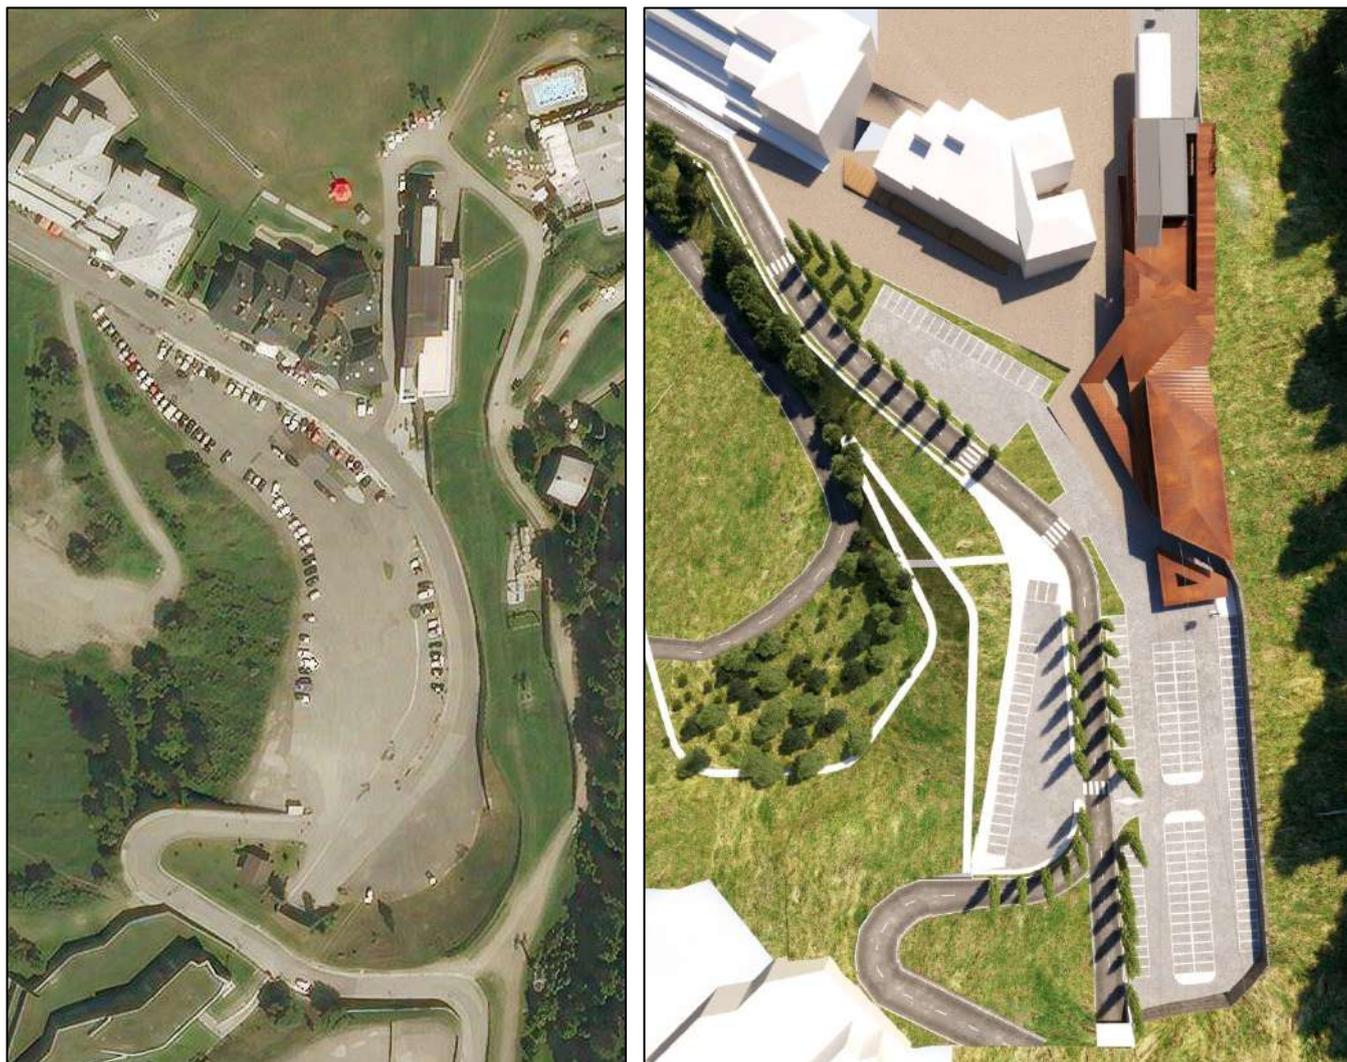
ASSETTO URBANISTICO E VIABILITÀ – STATO ATTUALE E RENDERE DI PROGETTO
